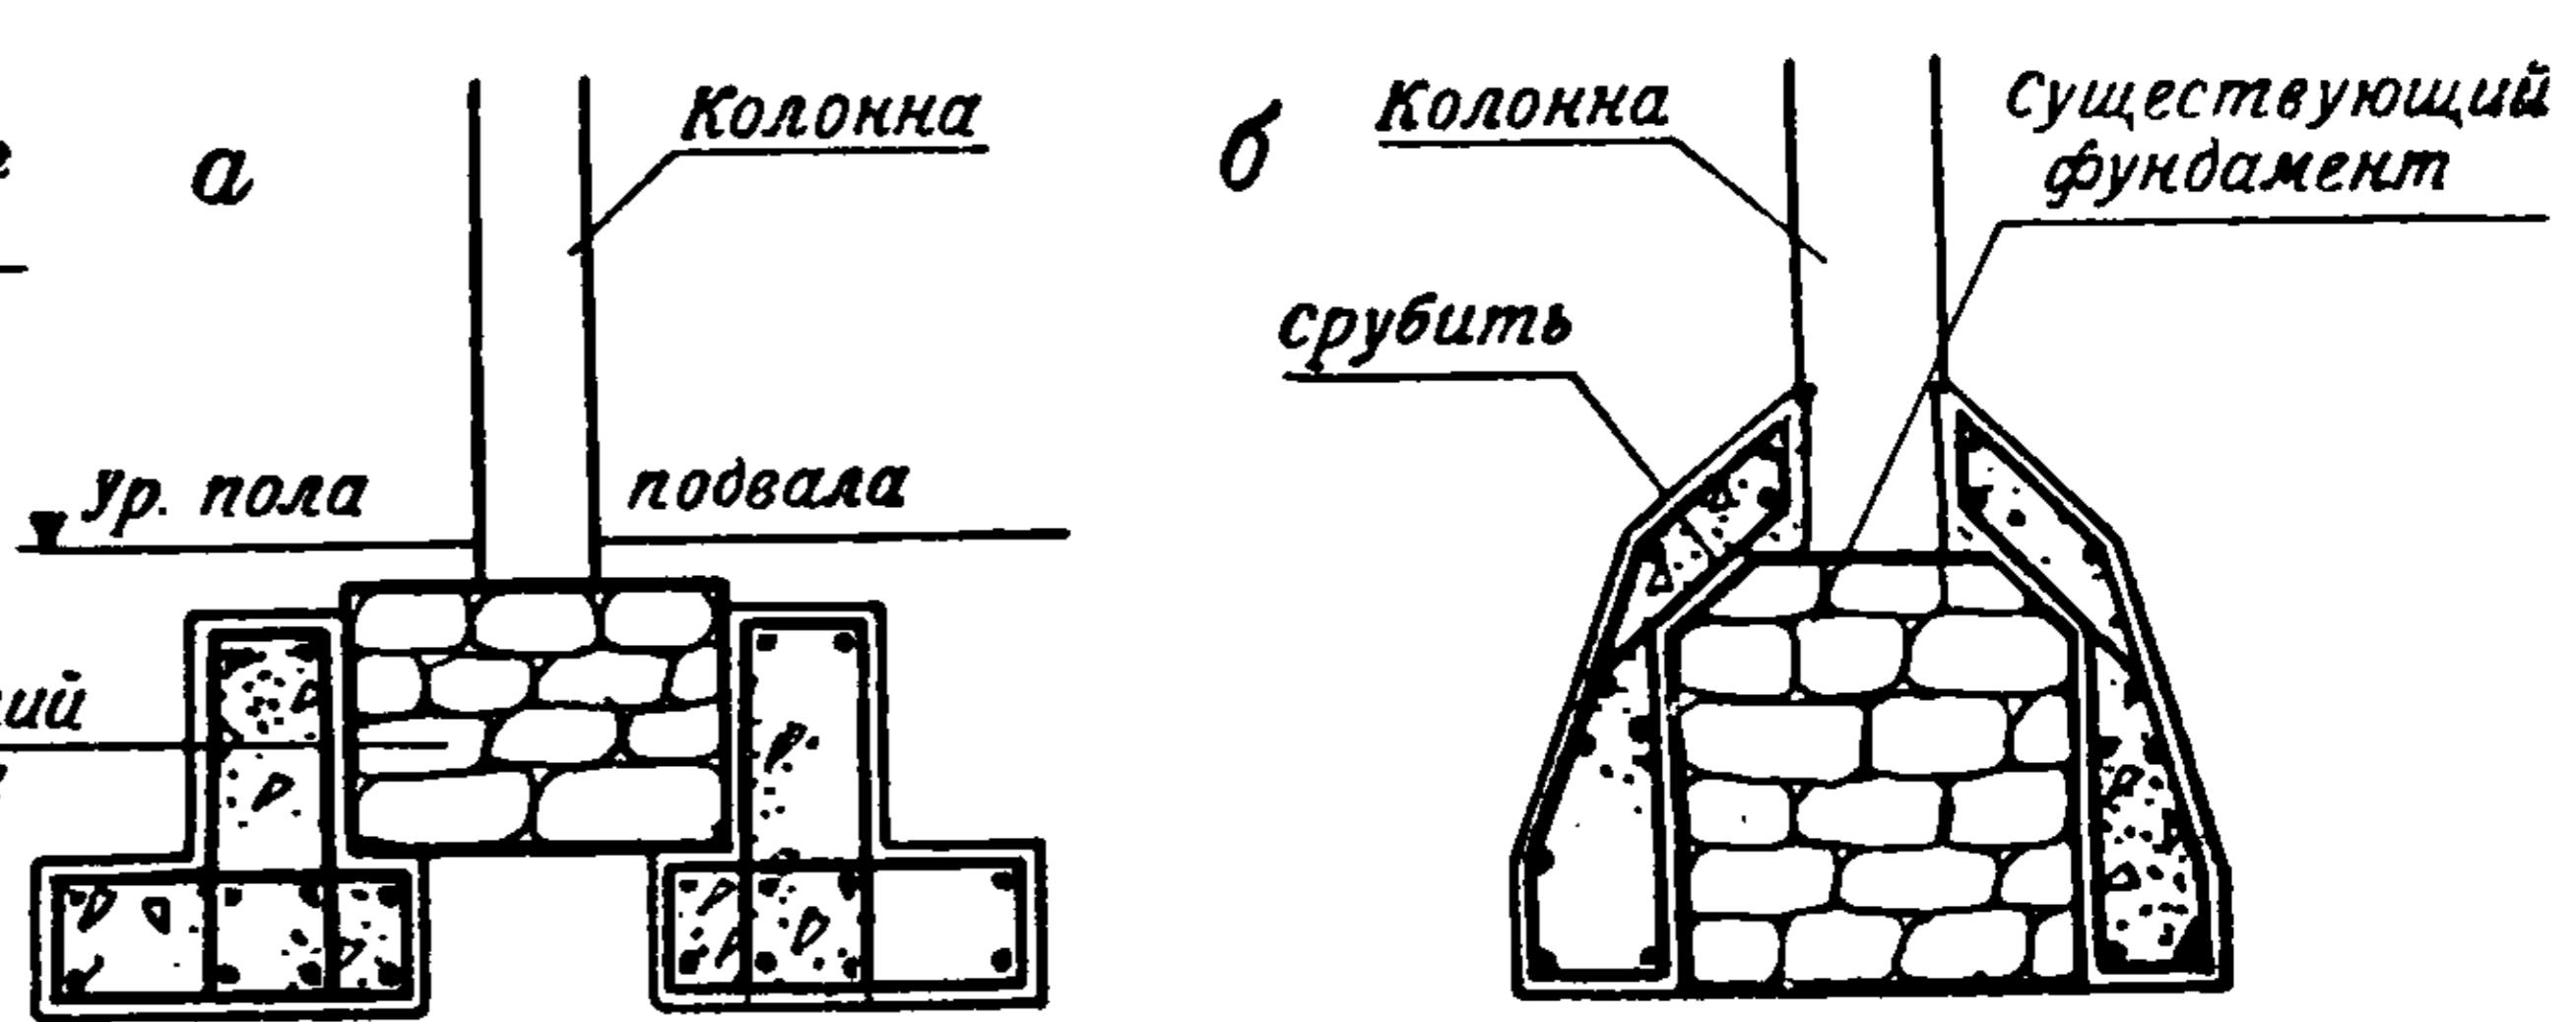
Варианты надстройки здания с перегруженными колоннами
